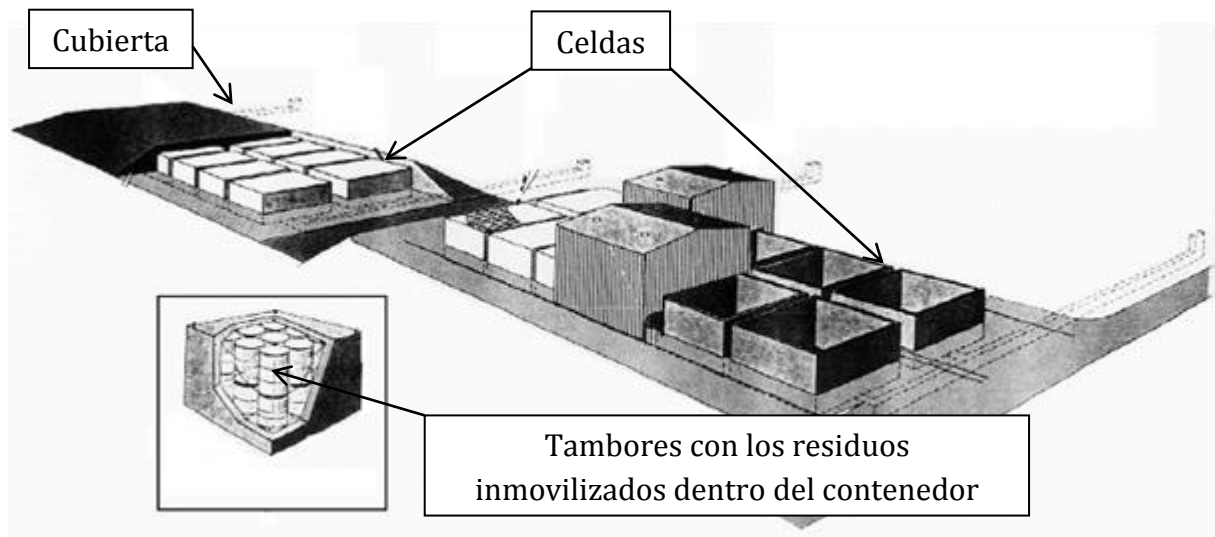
Sistema de barreras propuesto para la construcción del repositorio de RRNB.
